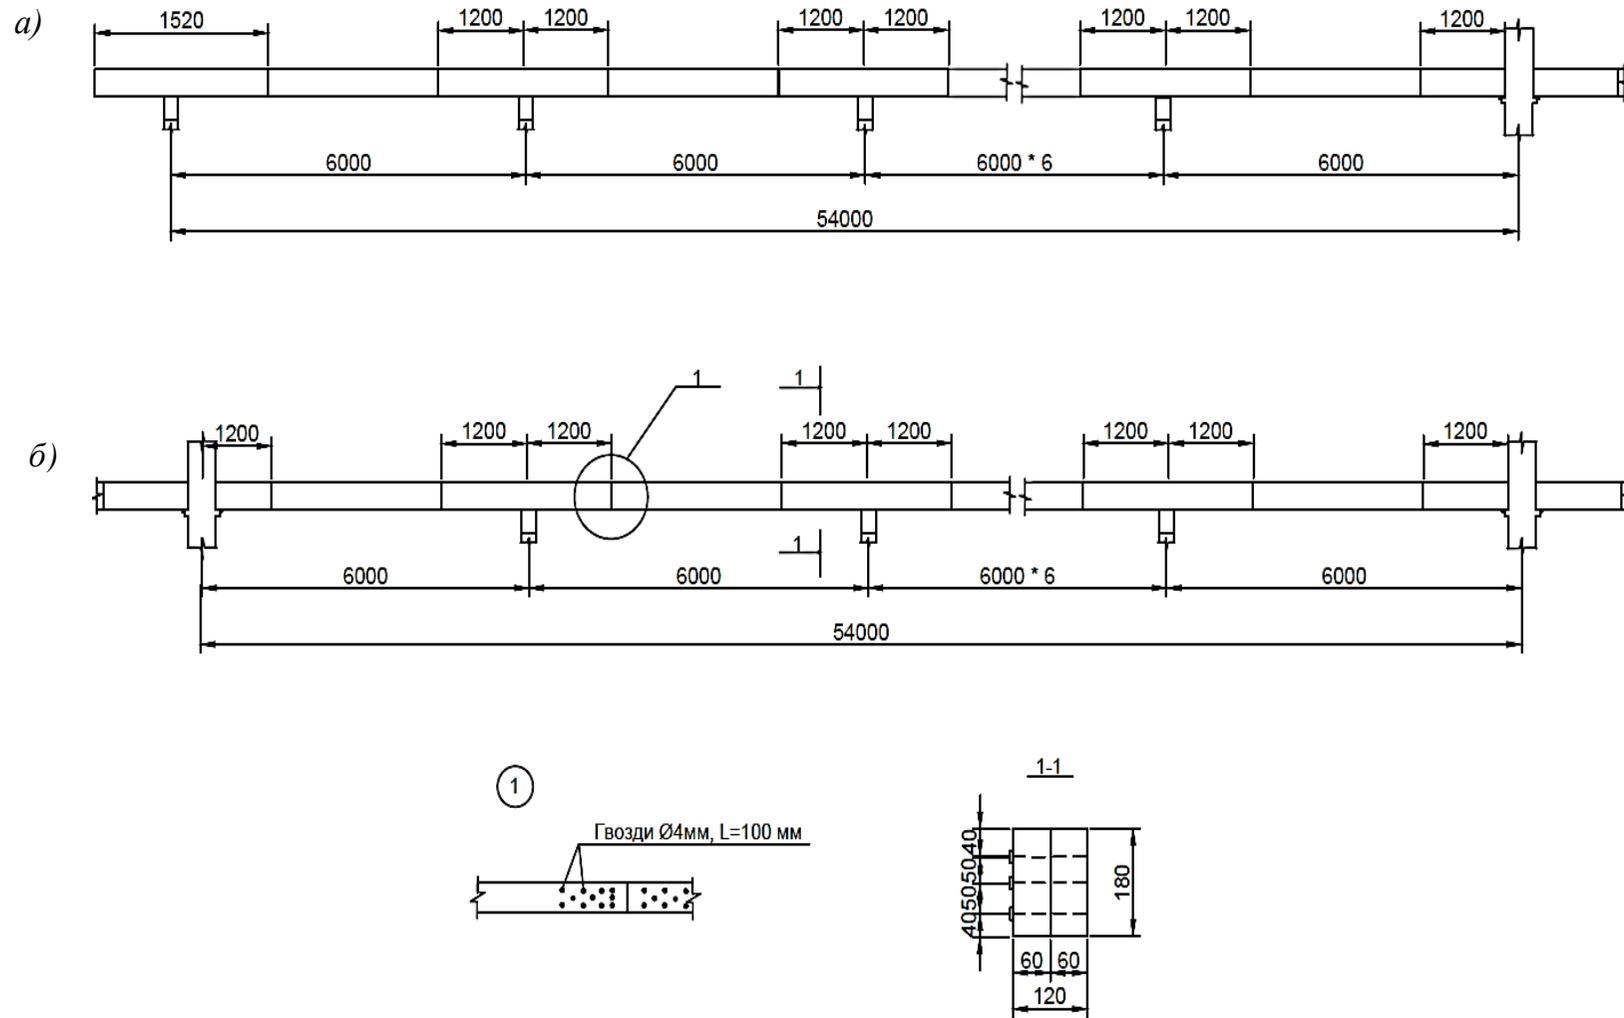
Конструкции неразрезных прогонов покрытия здания:
